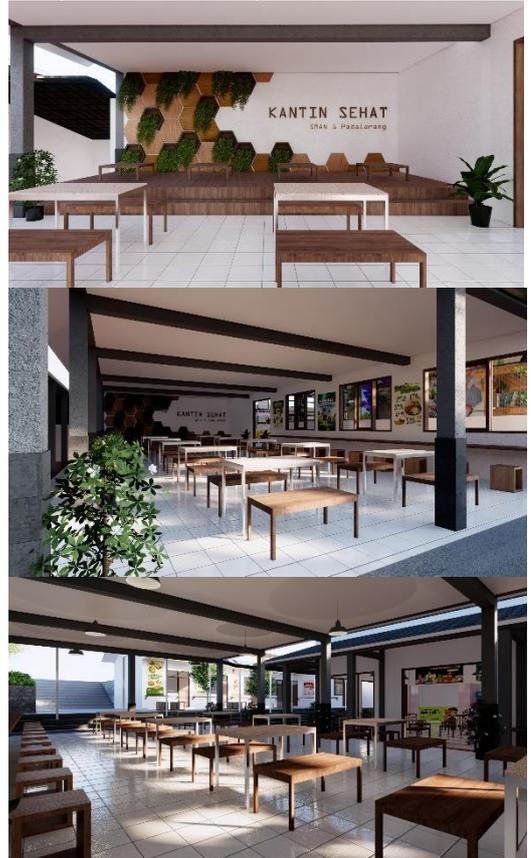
Perspektif Area Semi Outdoor dan Mural
